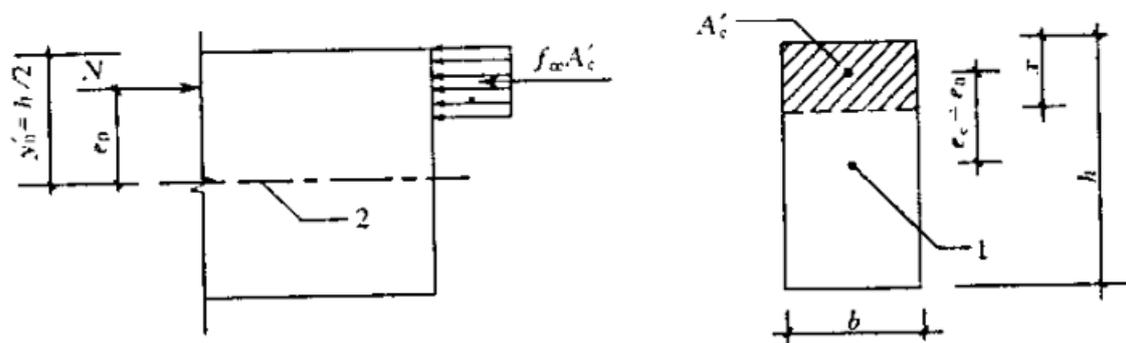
矩形截面的素混凝土受压构件受压承载力计算
